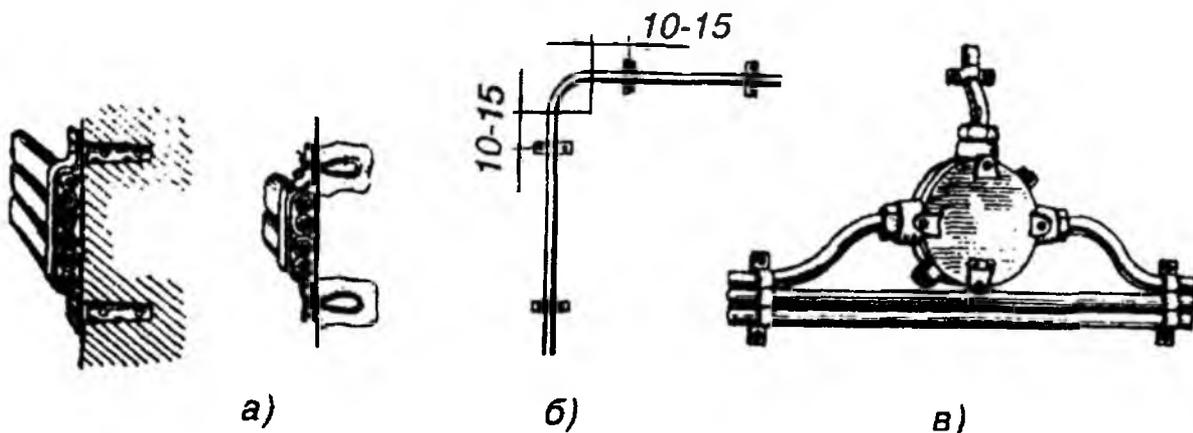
Монтаж электропроводок легкими кабелями с резиновой и пластмассовой изоляцией:
